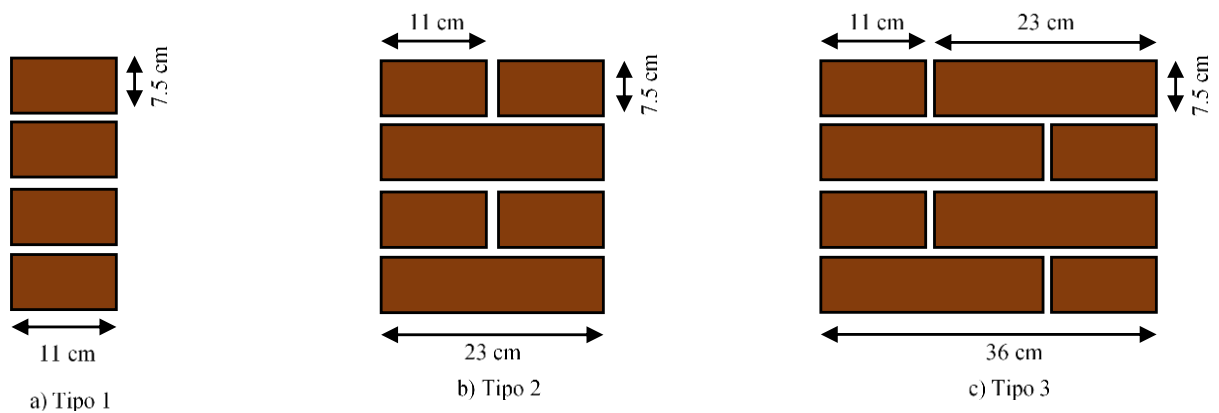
Arranjo dos tipos de paredes estruturais existentes.
